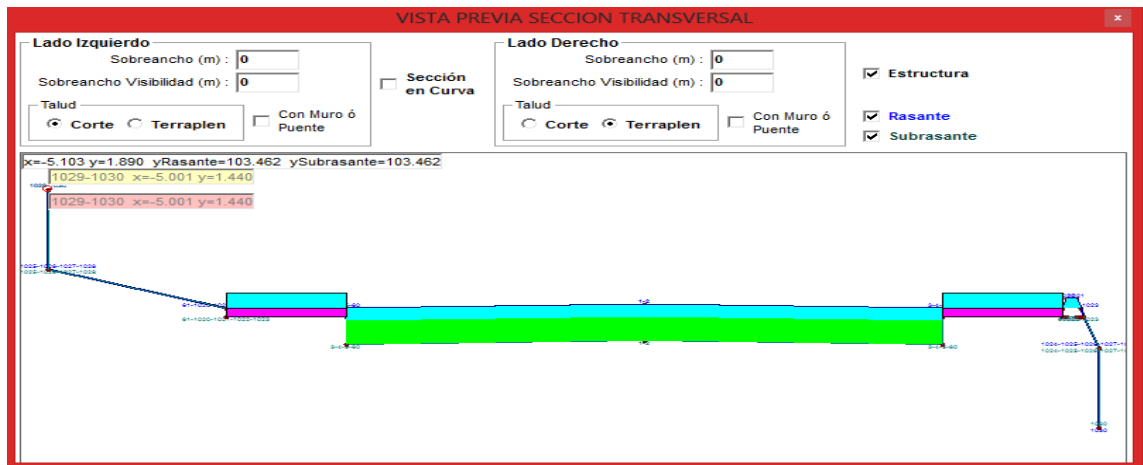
Vista preliminar sección transversal 17 de la vía interna2 entre abscisas 0-13 (m)
